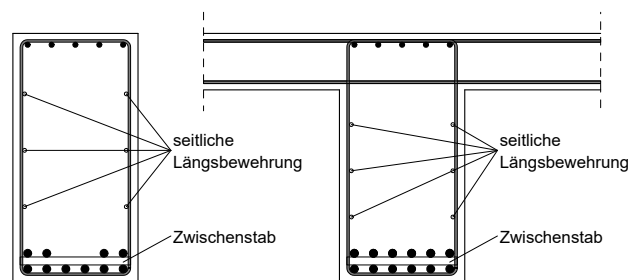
Träger – Zwischenstab und seitliche Bewehrung
